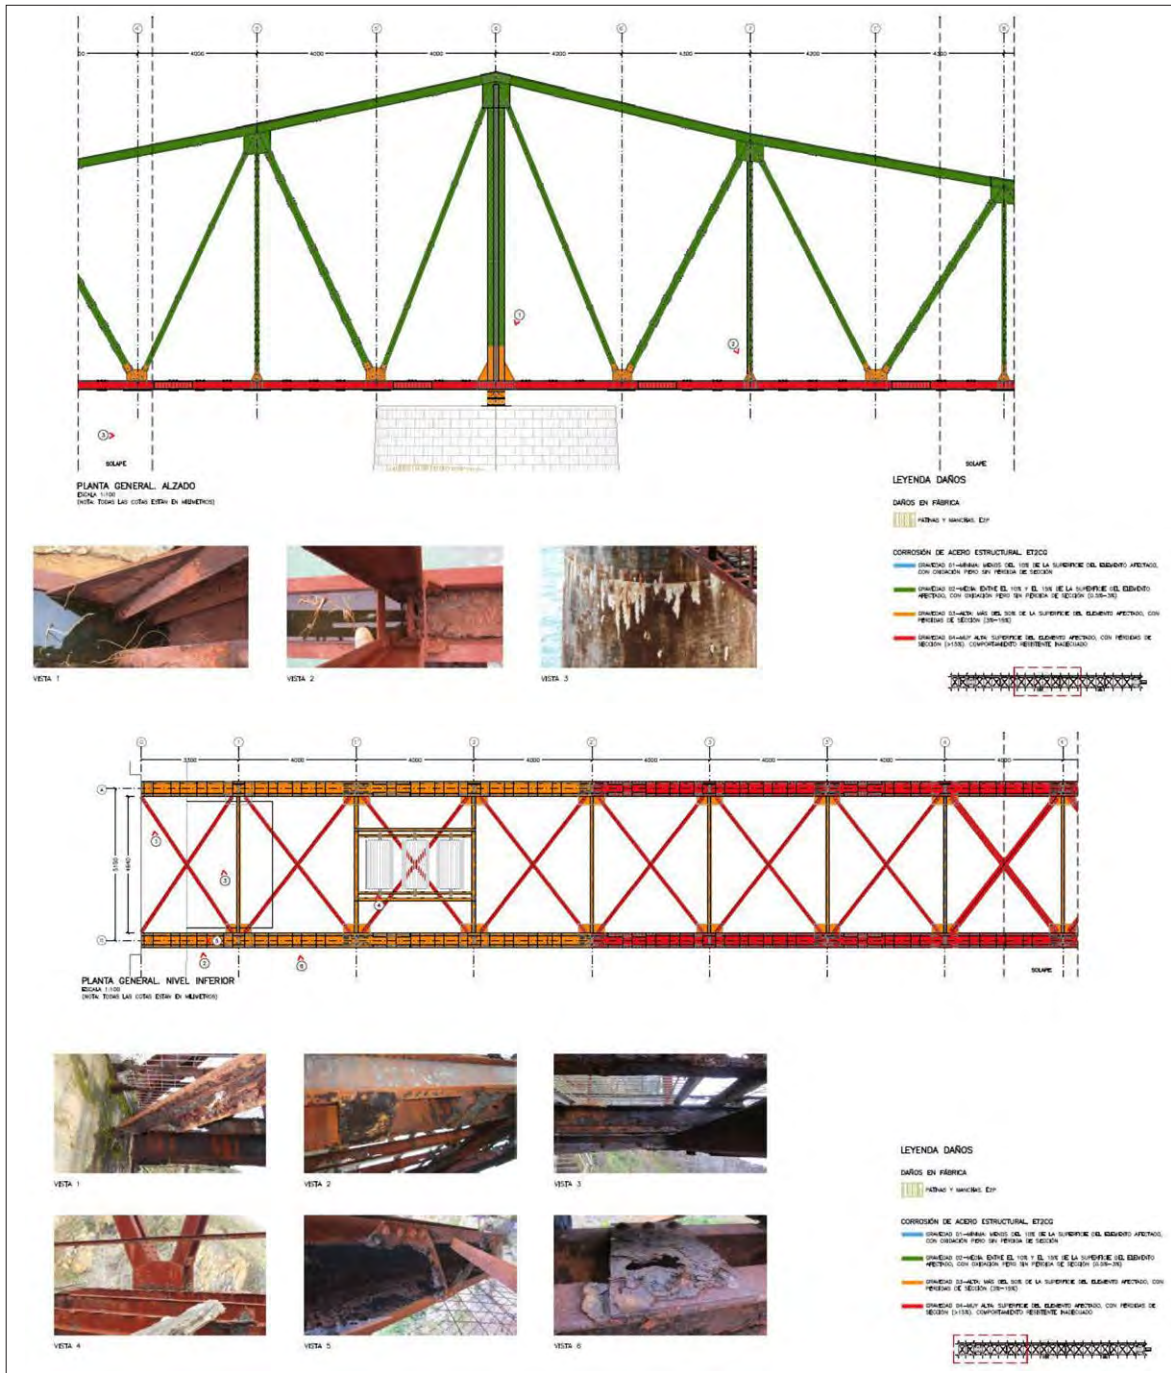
Daños en la estructura metálica, alzado y planta del tramo correspondiente a la pila del nivel inferior.
